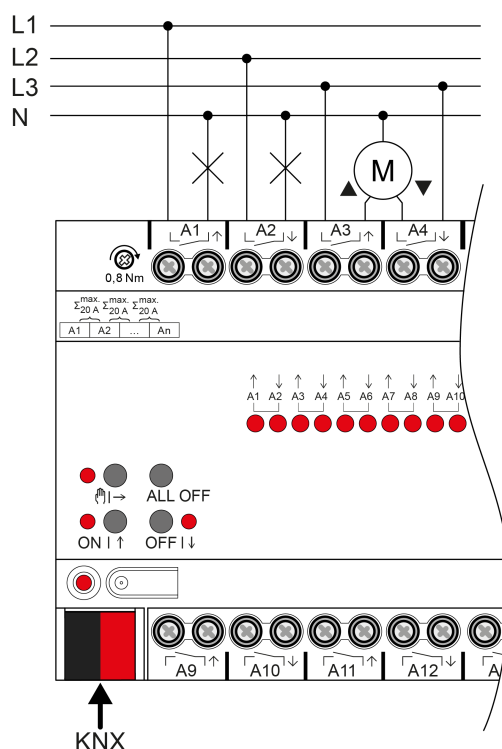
Conexión del dispositivo (ejemplo de conexión)
